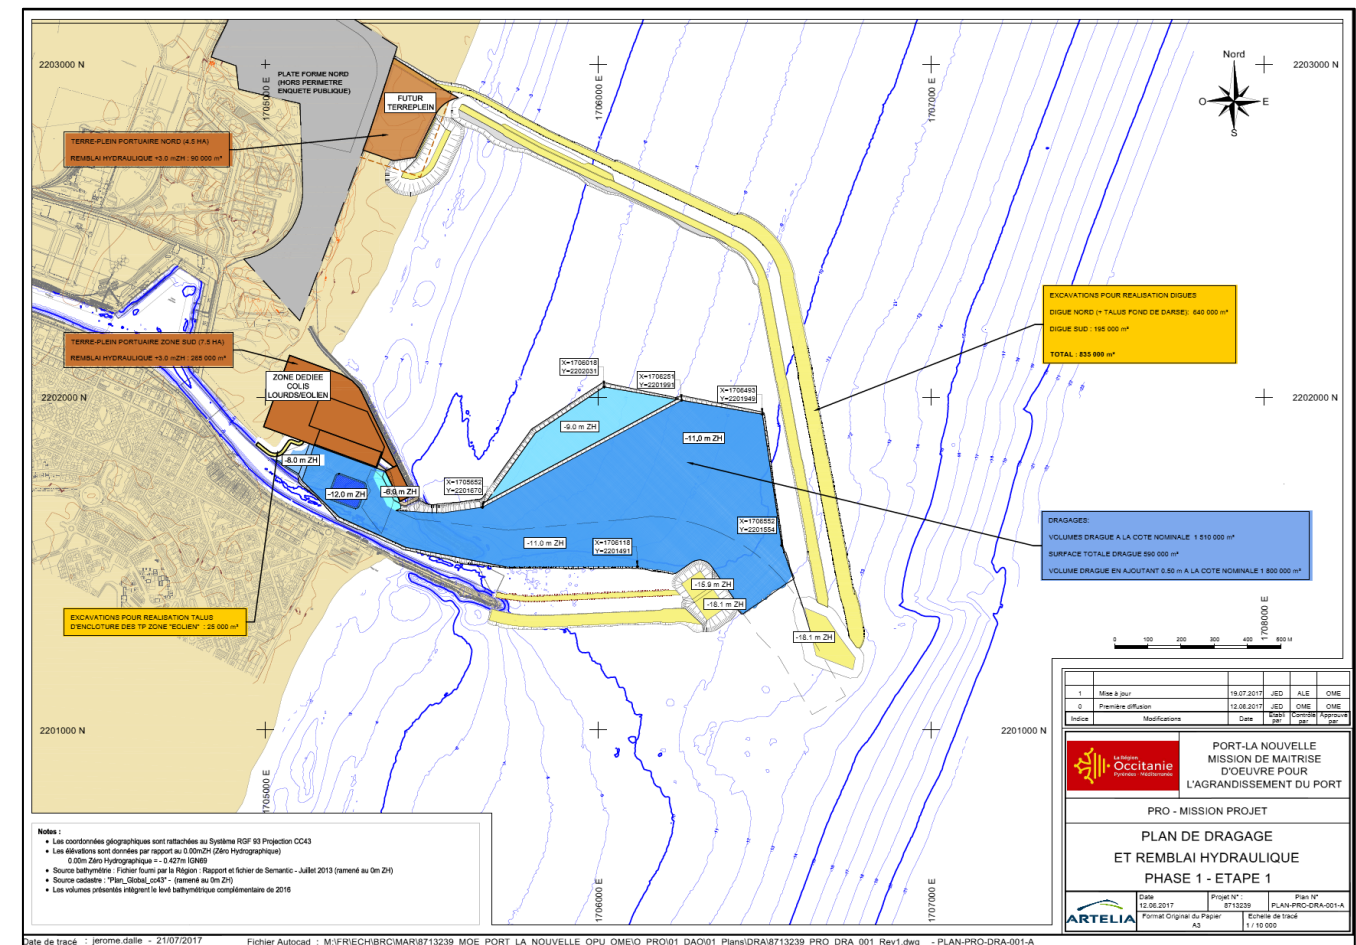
Plan de dragage et remblai hydraulique – Etape 1
